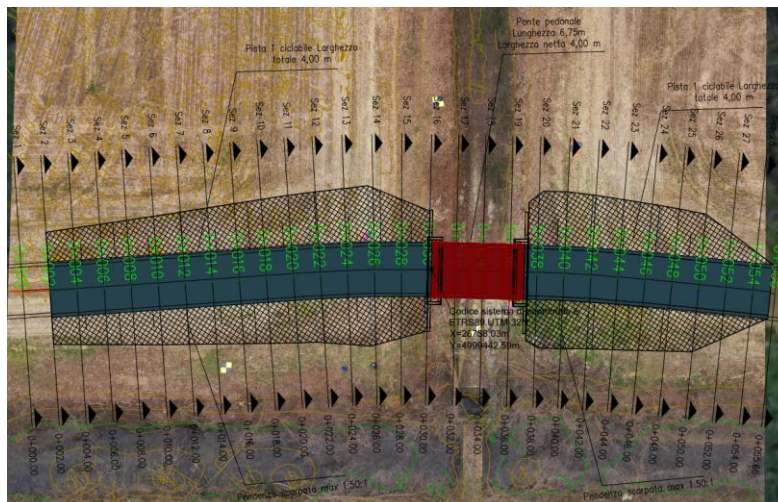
Planimetria del tracciato (locale) – Ponte pedonale 1D
